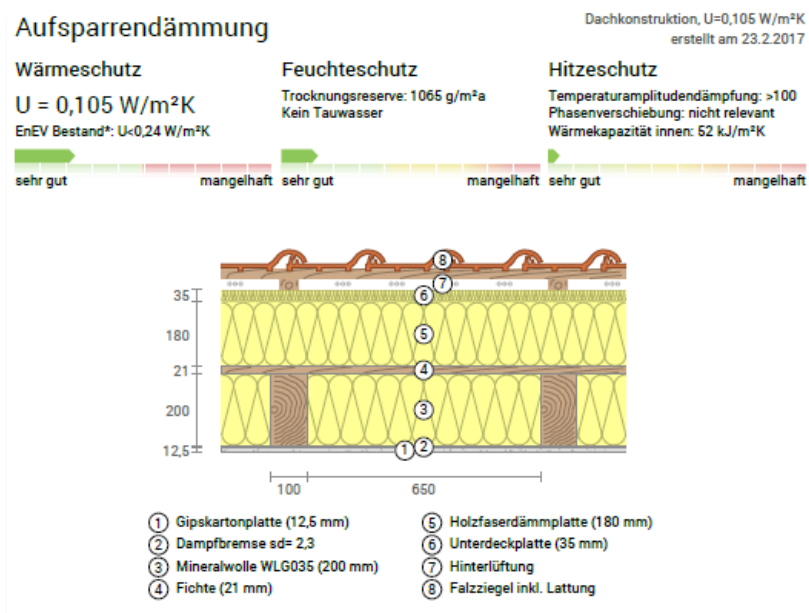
Schichten des Dachaufbaus nach Sanierung
